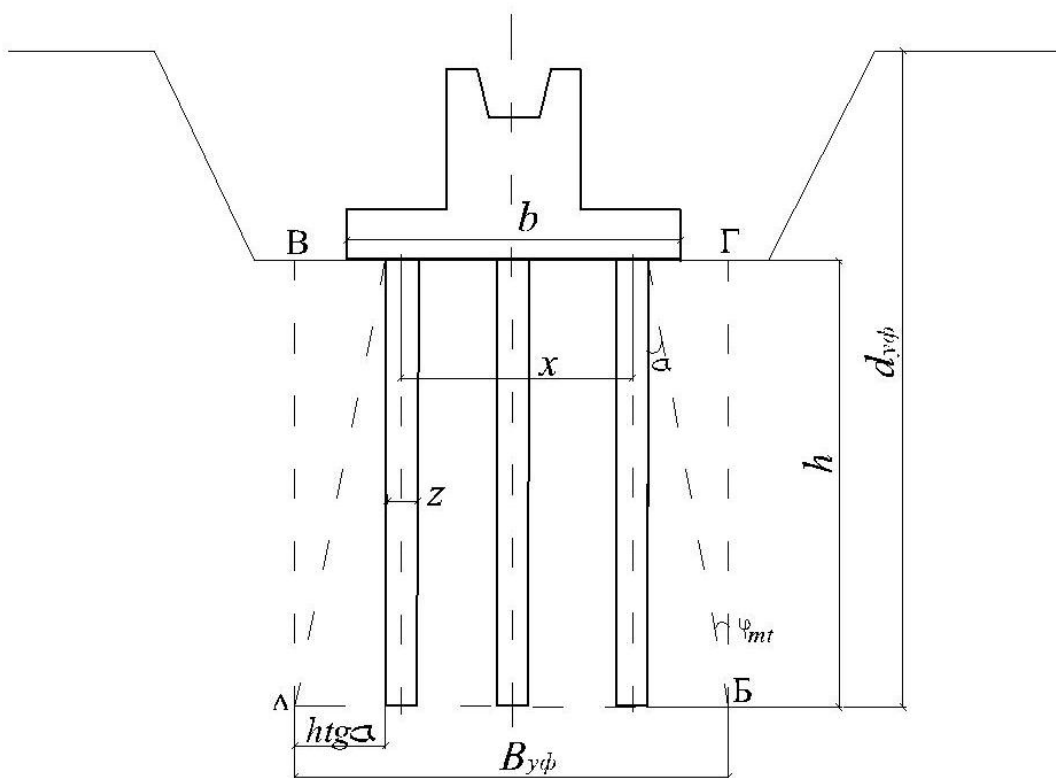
Расчетная схема свайного фундамента по деформациям
